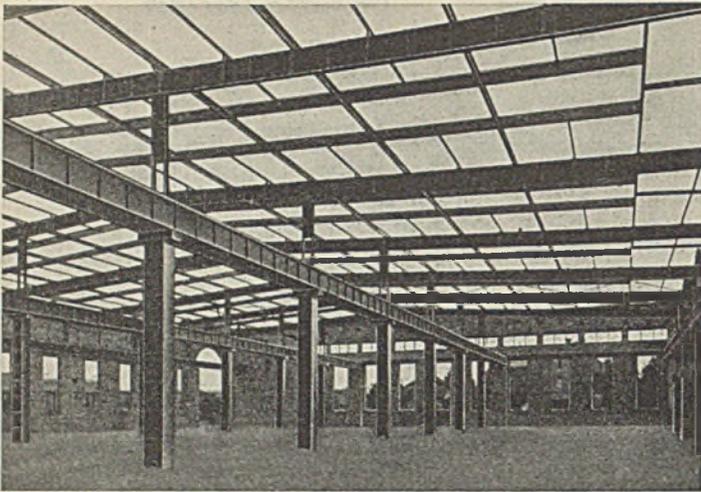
Montagehalle fertig montiert ohne Dachdeckung.
